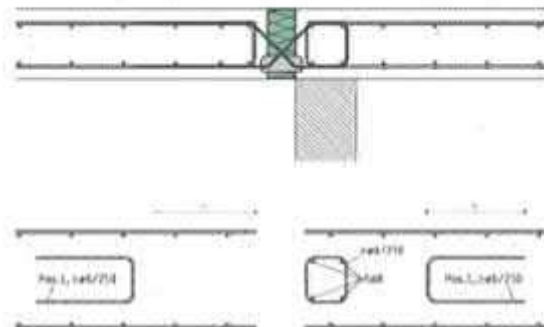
Bewehrungsführung QQ bei direkter Lagerung und deckenseitig geschlauften Querkraftstäben
